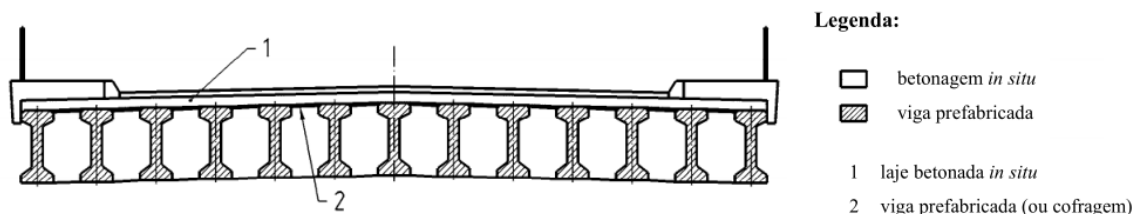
Tabuleiro em vigas I pré-fabricadas com laje betonada *in situ* (NP EN 15050, 2008)
